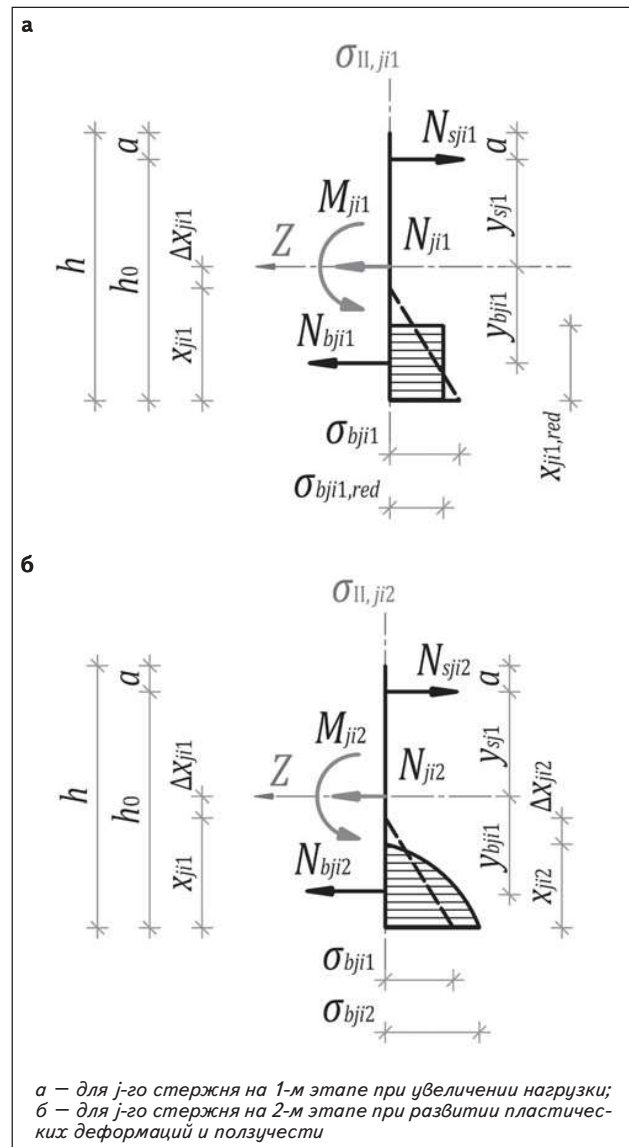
Эпюры нормальных напряжений сжатой зоны бетона
